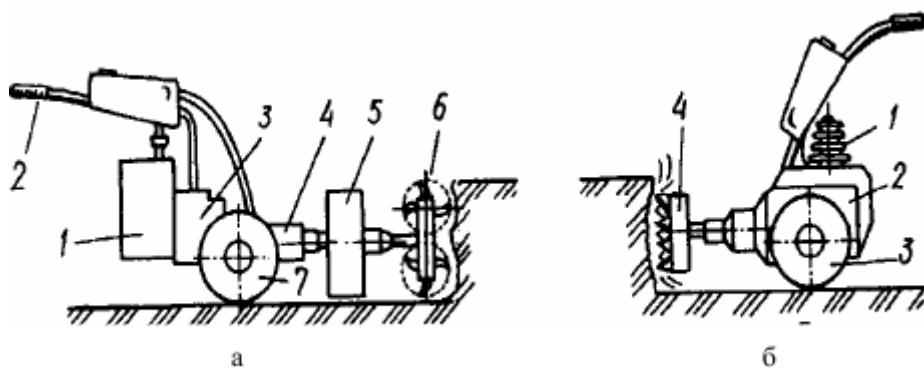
Ручний механізований землерийно-транспортувальний інструмент: а - модель ЗМТИ-1 (1 - двигун; 2 - рукоятка; 3 - рама; 4 - редуктор; 5 - металевий ґрунтогенератор; 6 - грунторозріблювальні фрези; 7 - колеса); б - модель ЗМТИ-3 (1 - двигун; 2 - редуктор; 3 - колеса; 4 - робочий орган)
